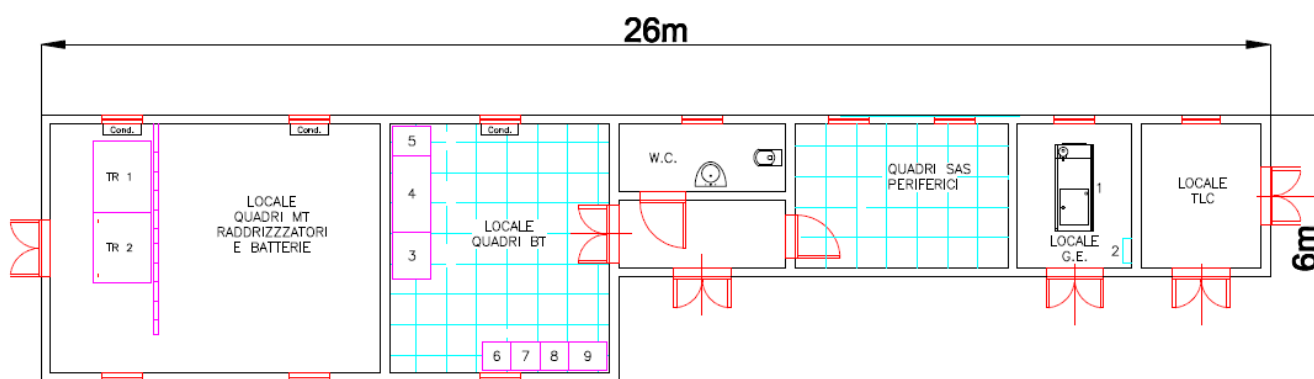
Stralcio planimetria interventi interni alla Stazione Elettrica esistente
